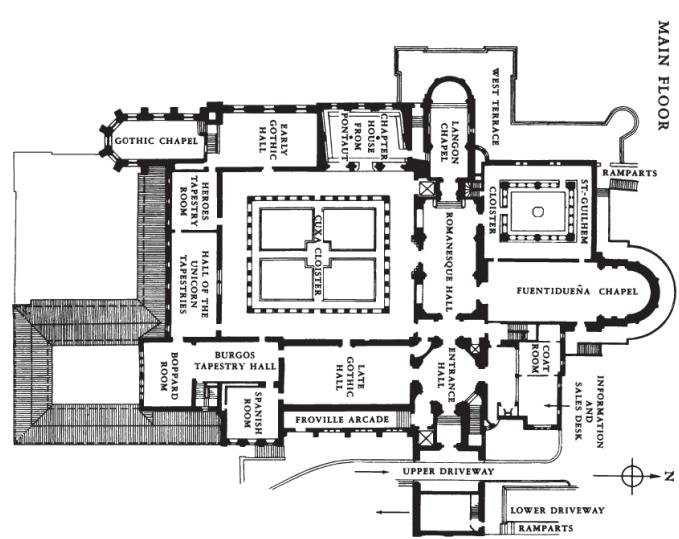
Plano de la planta principal de The Cloisters en el catálogo del museo en 1941
